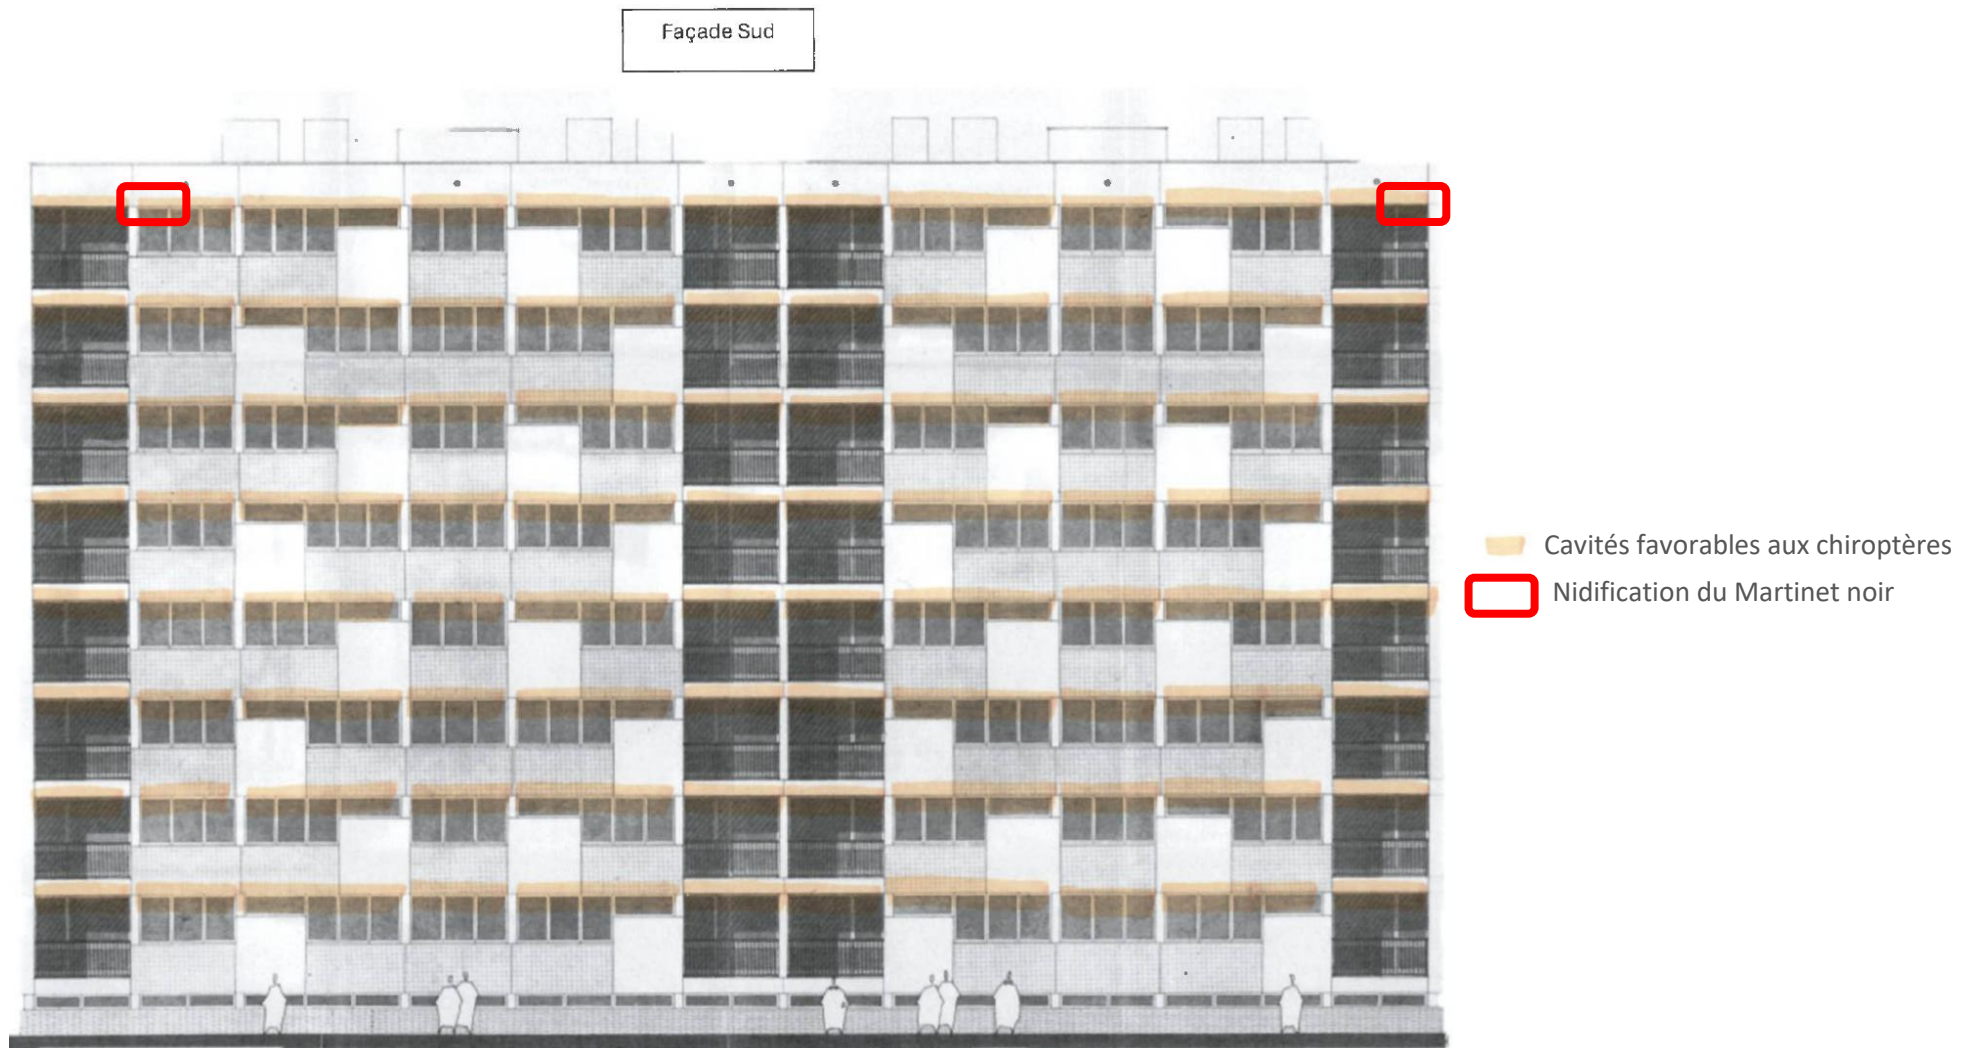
Plan du bâtiment 21 (façade sud) des cavités favorables aux chiroptères et de la nidification des Martinets noirs
